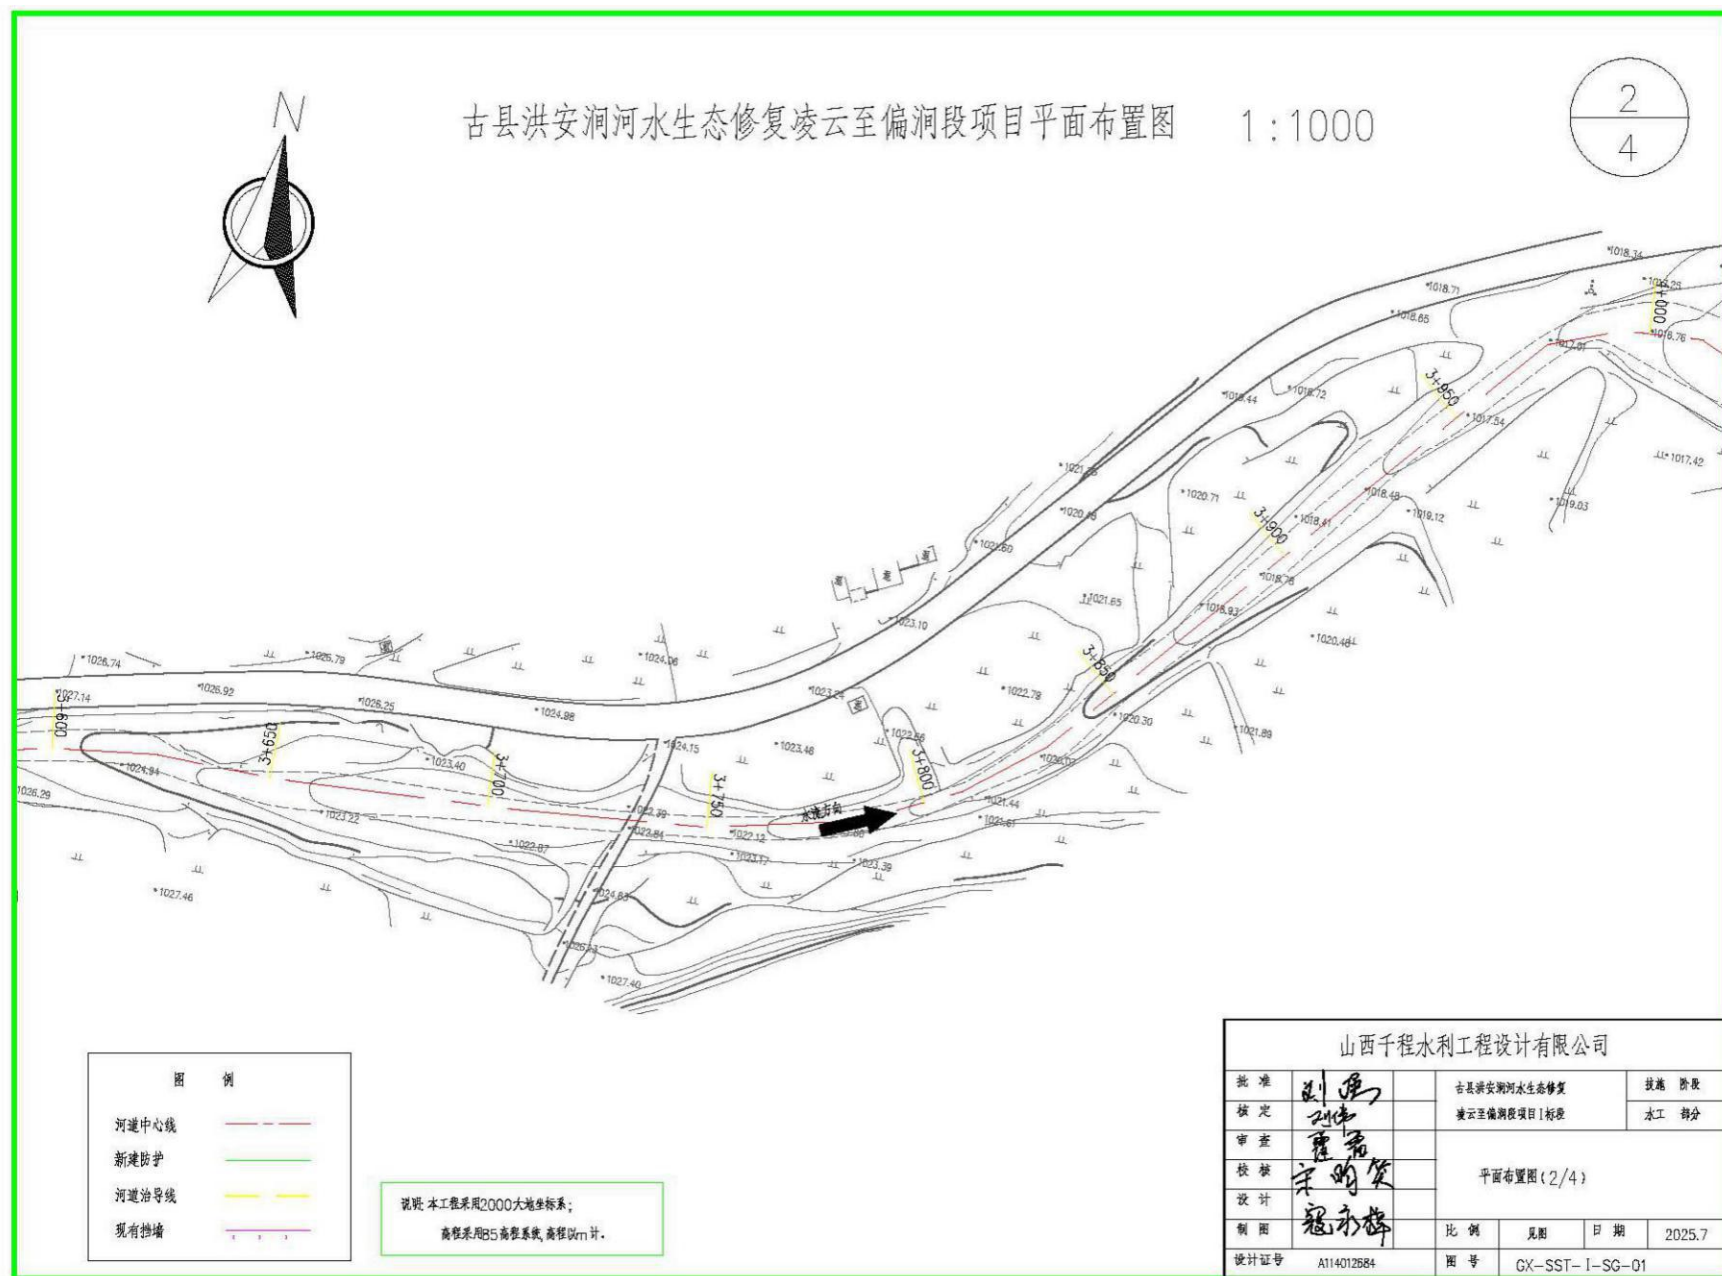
(2) 工程总平面布置图 (桩号 3+600-4+000)
